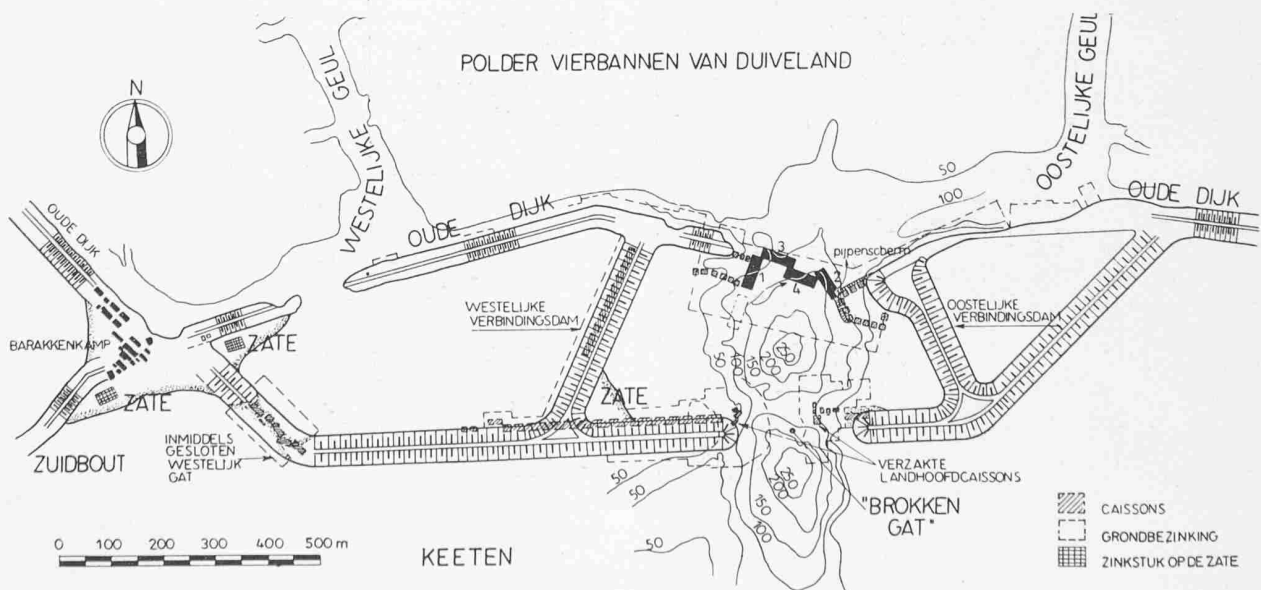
Der Deichschluss bei Ouwerkerk, Lageplan 1:14000 aus «De Ingenieur» vom 13. November 1953
